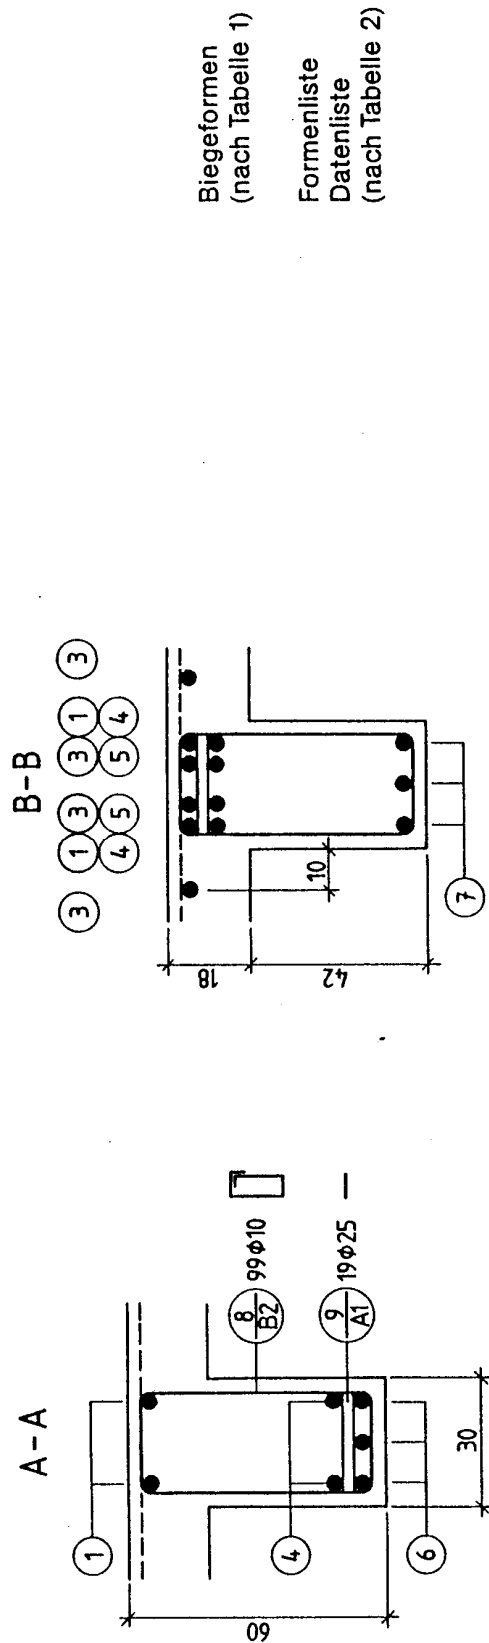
Bewehrungsplan für einen Stahlbetonunterzug (Darstellungsart 2)
